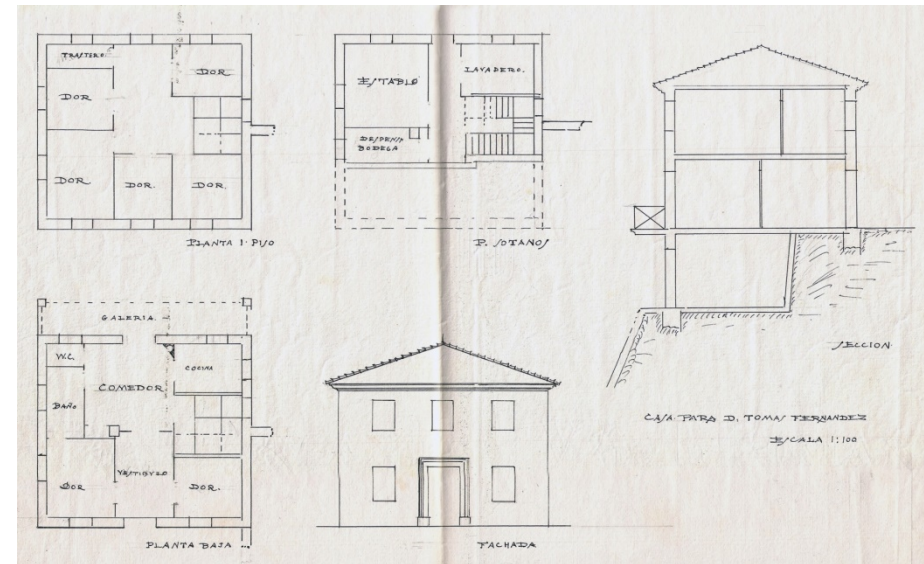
Plano del proyecto de Casa para D. Tomás Fernández (1923-1929).<sup>456</sup>
